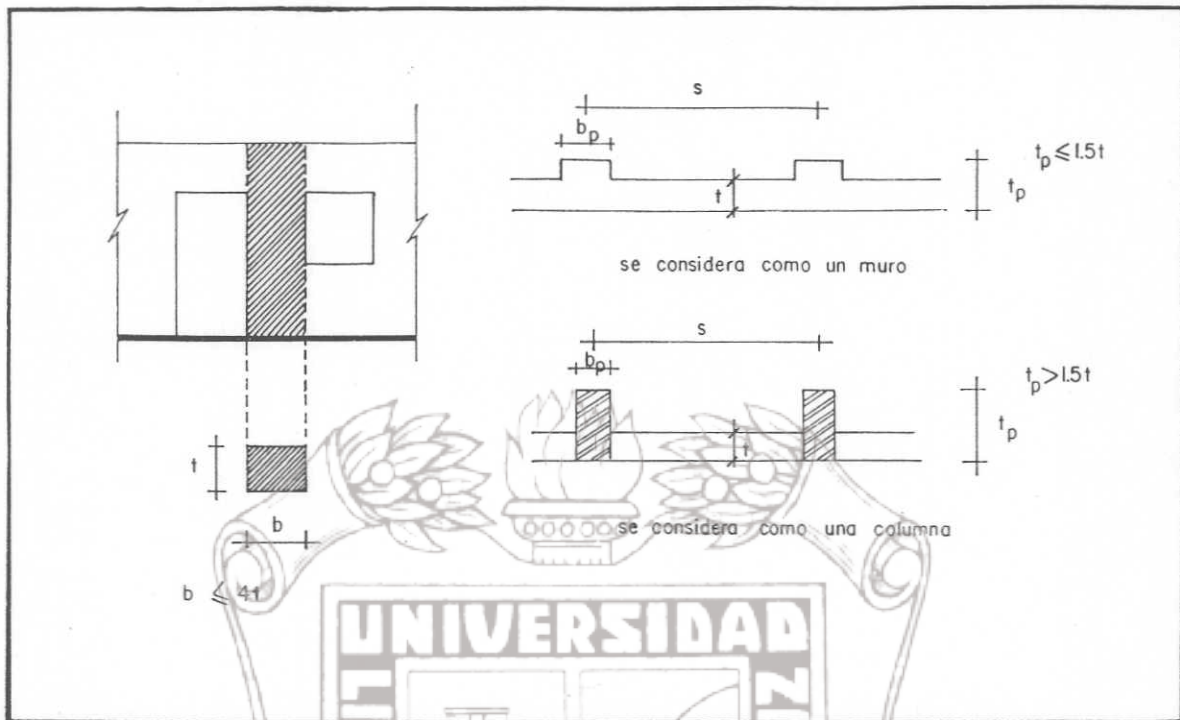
(a) Columnas formadas por vanos adyacentes. (b) Columnas adosadas en los muros.
